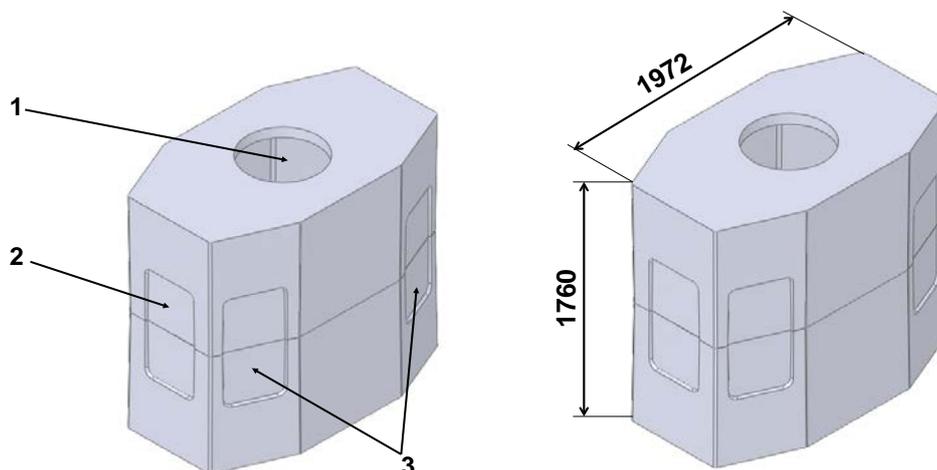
Детали и габаритные размеры колодца «ККСр-3,5-80» в сборе: 1 – круглое отверстие для люка, диаметр 600 мм; 2 – ниша на торцевой стене верхнего элемента; 3 – ниши на боковых стенах элементов.
